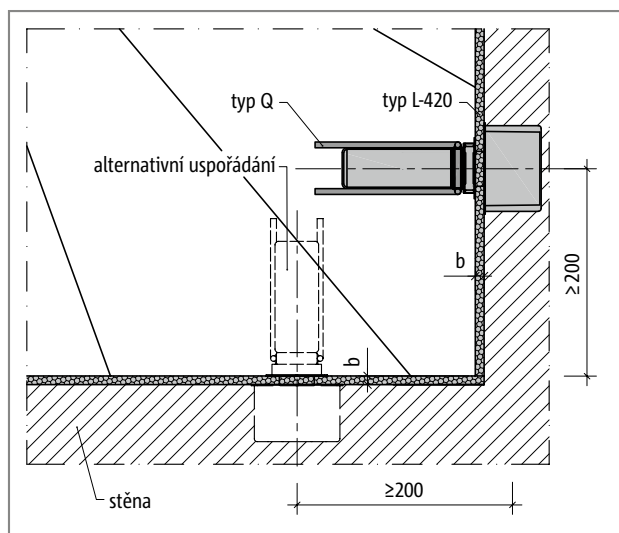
Schöck Tronsole® typ Q-FV-XL nebo Q-A2-XL: Řez napojením prefabrikovaného ramene
